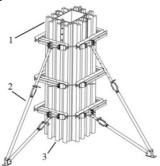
Балочно-ригельная опалубка колонн 1- щит, 2 - подкос, 3 - анкерный тяж
